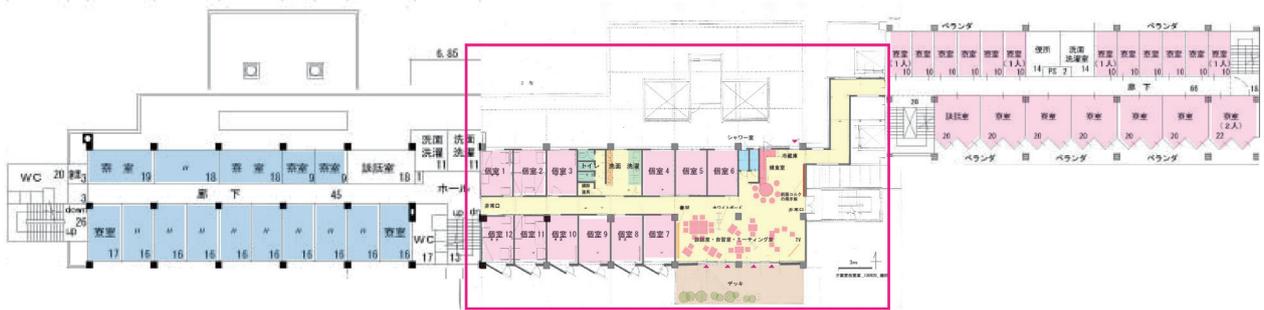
北寮の2階の東側を女子寮に改築した北寮、夕葉寮2階平面図
